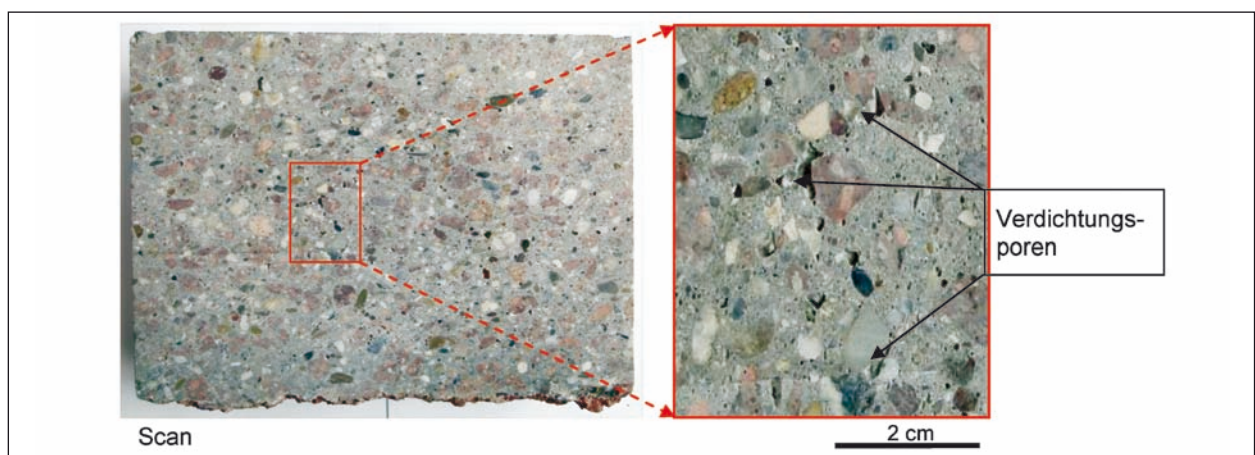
Vertikalschnitt durch Betonfahrbahndecke der A 14 (links) mit Detailausschnitt
